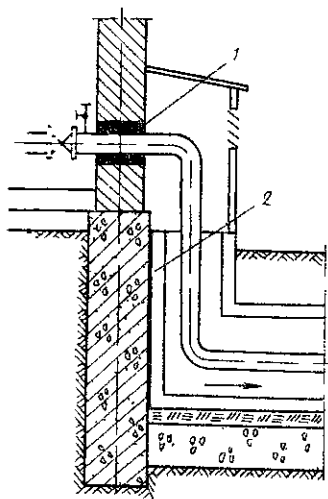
Ввод трубопровода, проложенного по принципу сохранения мерзлоты в основаниях, в здание, допускающее протаявание оснований
